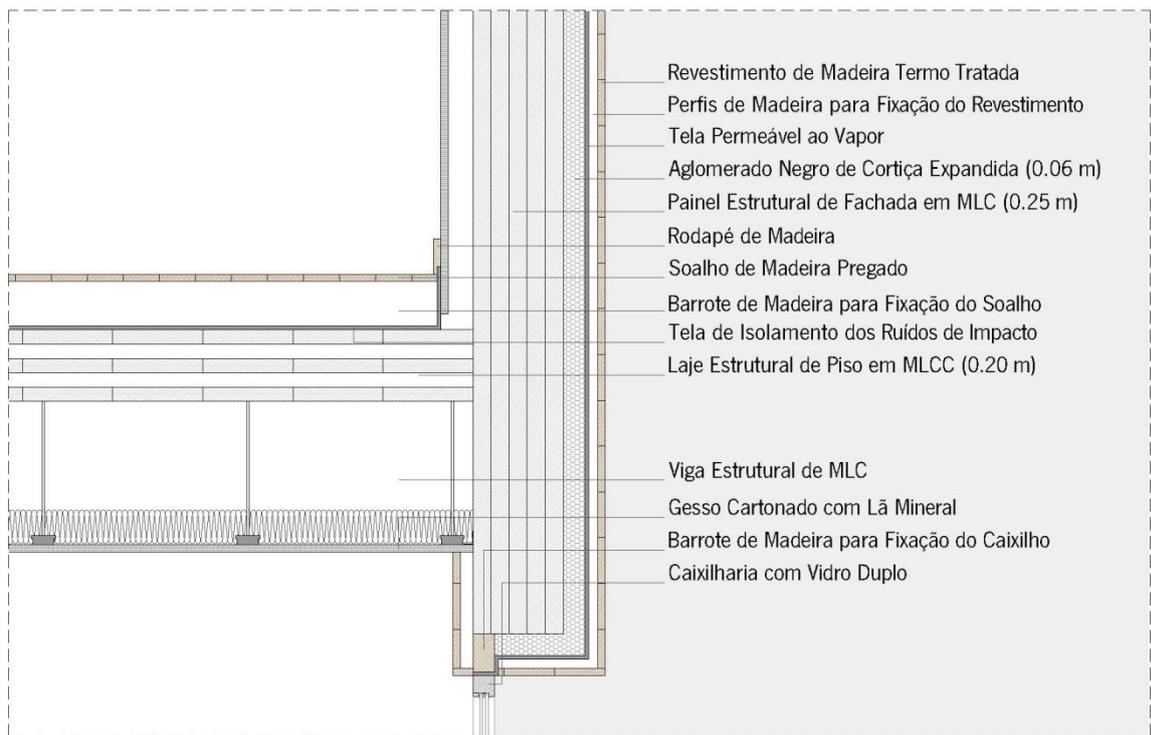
Pormenor Construtivo da Parede Exterior para o Edifício Proposto (Esc. 1/20)
